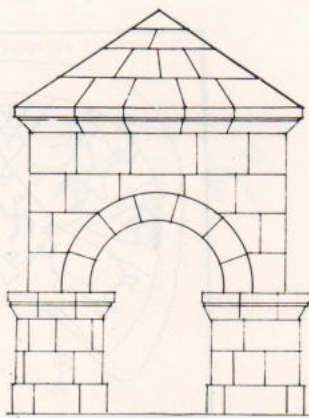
Фасад «сооружения о четырех пилонах» (реконструкция автора)
